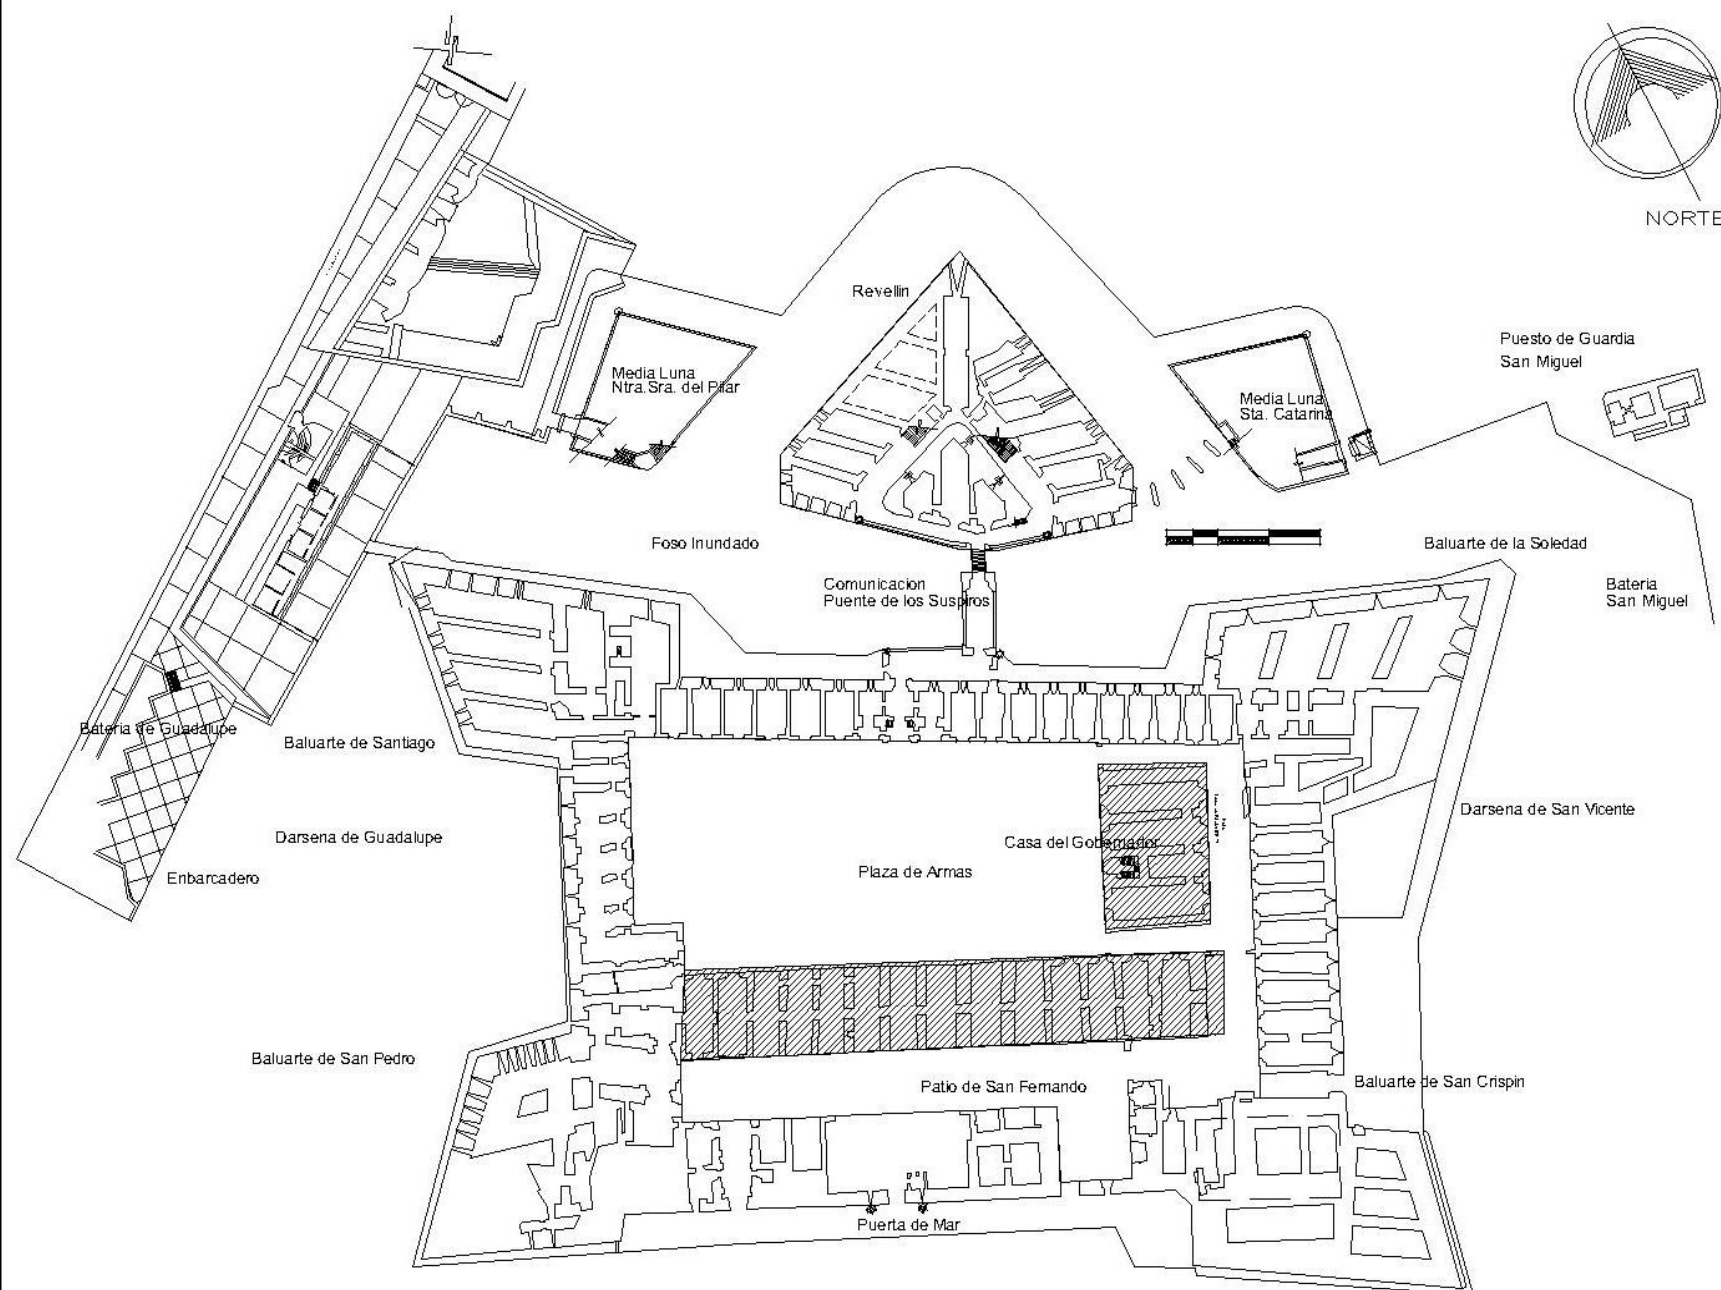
Proceso constructivo autorizado en 1794 para la construcción de la casa de castellán. Se observa la cortina interior que posteriormente sería la cortadura de San Fernando. Edito plano: Arq. Angelina del Carmen González Díaz. 2015
